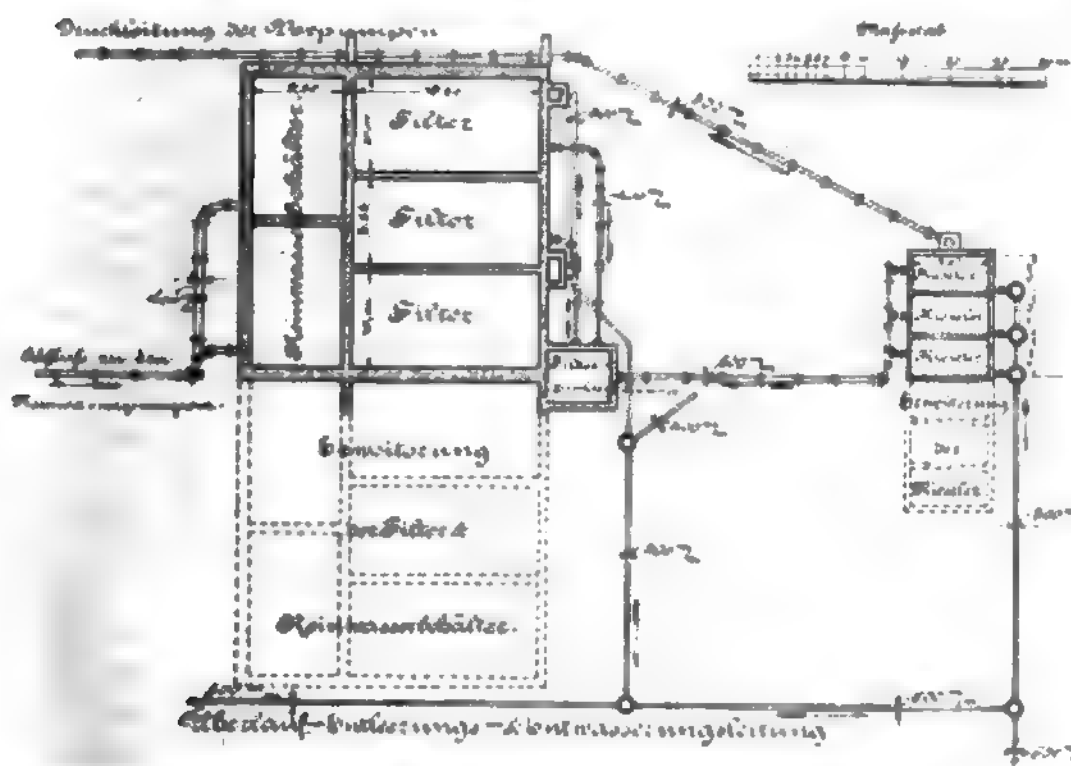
Wasserwerk Forst i.L. Lageplan der Enteisungsanlage.
